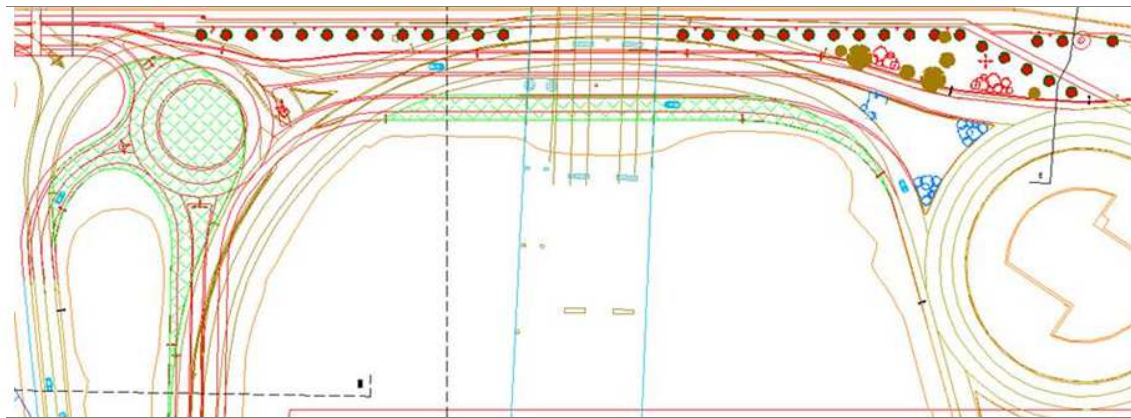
Área da intervenção “Qualificação urbana da ligação entre a Rotunda das Pirâmides e a Ponte das Eclusas”
